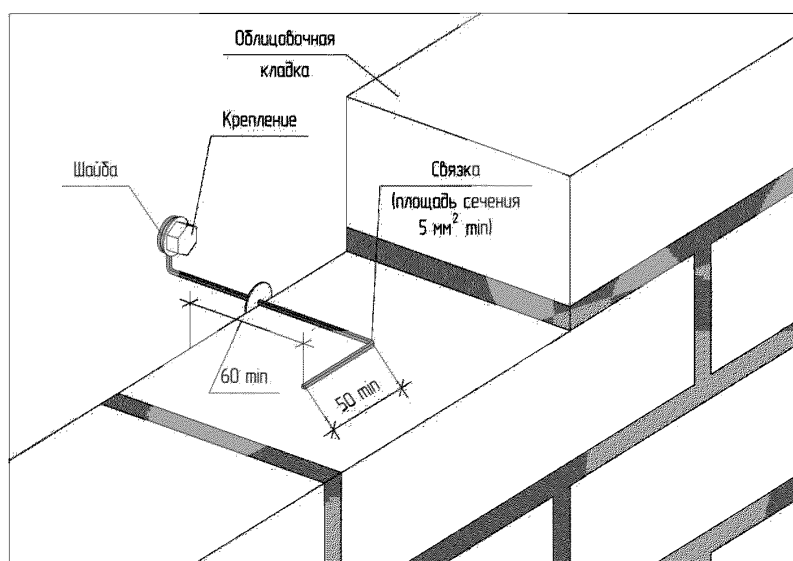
Схема устройства анкерно-связки для крепления облицовочной кладки
